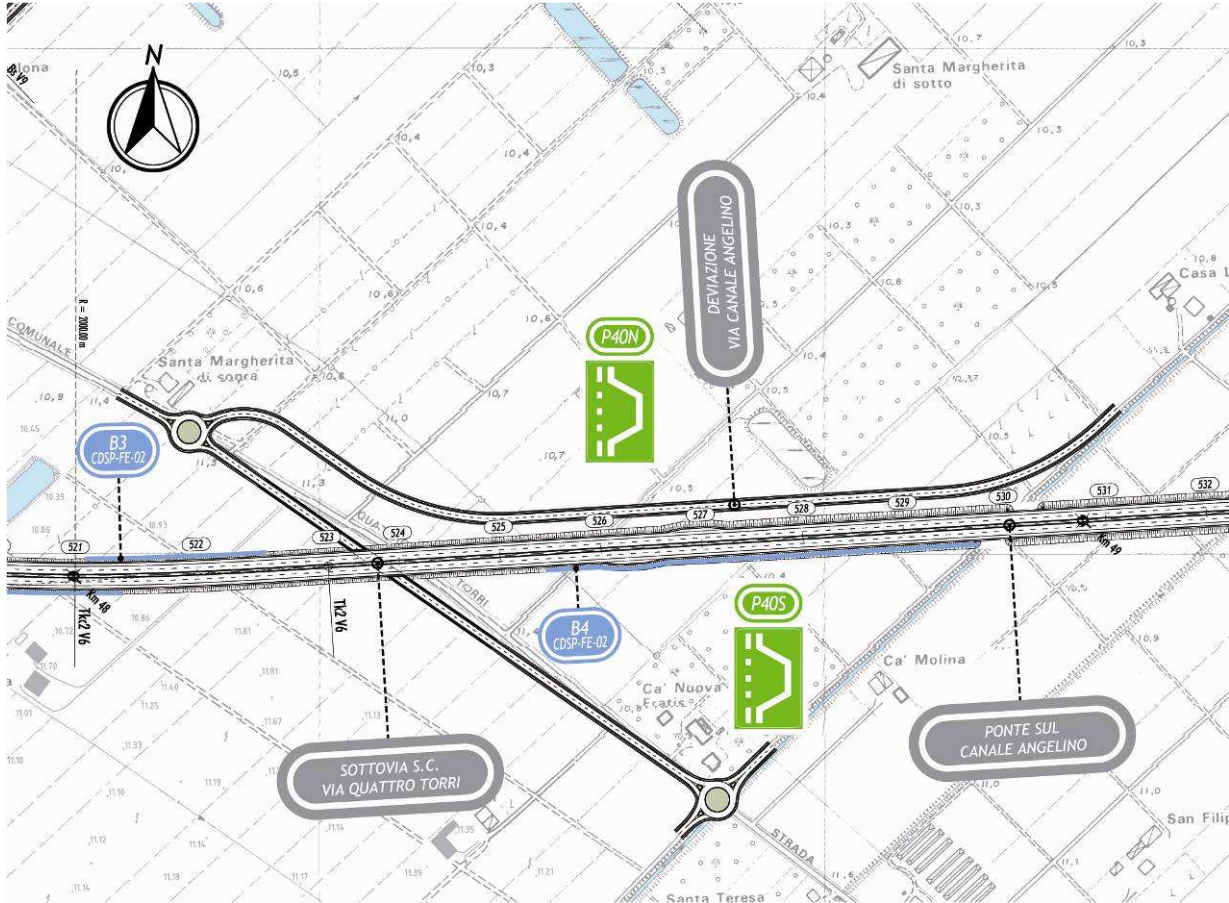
STRALCIO PLANIMETRICO VIA QUATTRO TORRI
